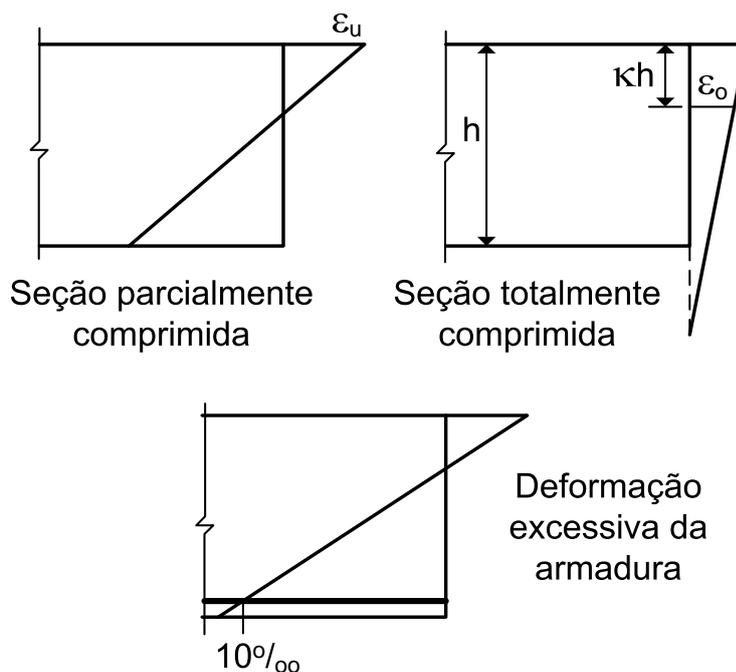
Situações de ruptura de uma seção de concreto armado (flexão)
